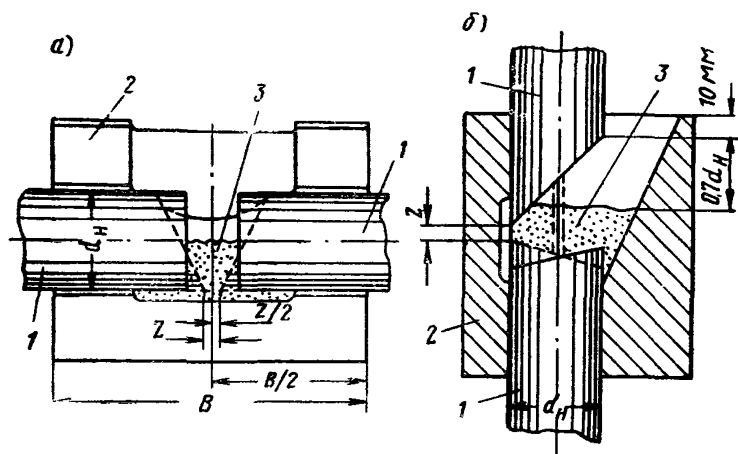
Рекомендуемые расположения и установочные размеры сборки медных форм для сварки стыковых соединений стержней
